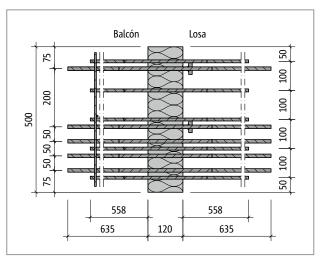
Schöck Isokorb® XT tipo C-R-M1-V1: Plano del producto
